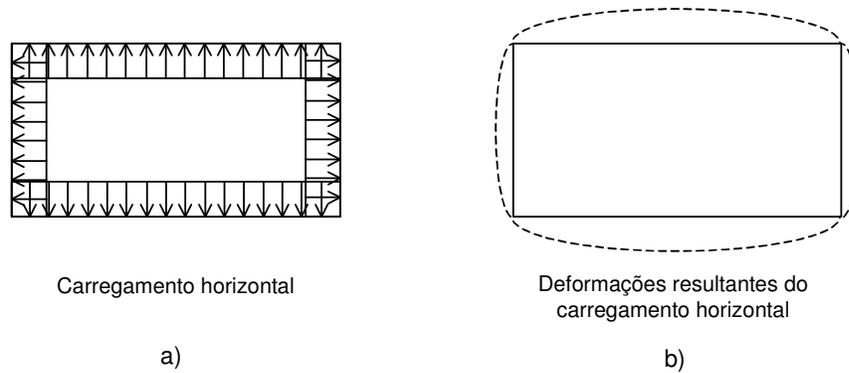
Corte transversal de pilar representando esquematicamente: a) cargas horizontais; b) deformações das fôrmas.
